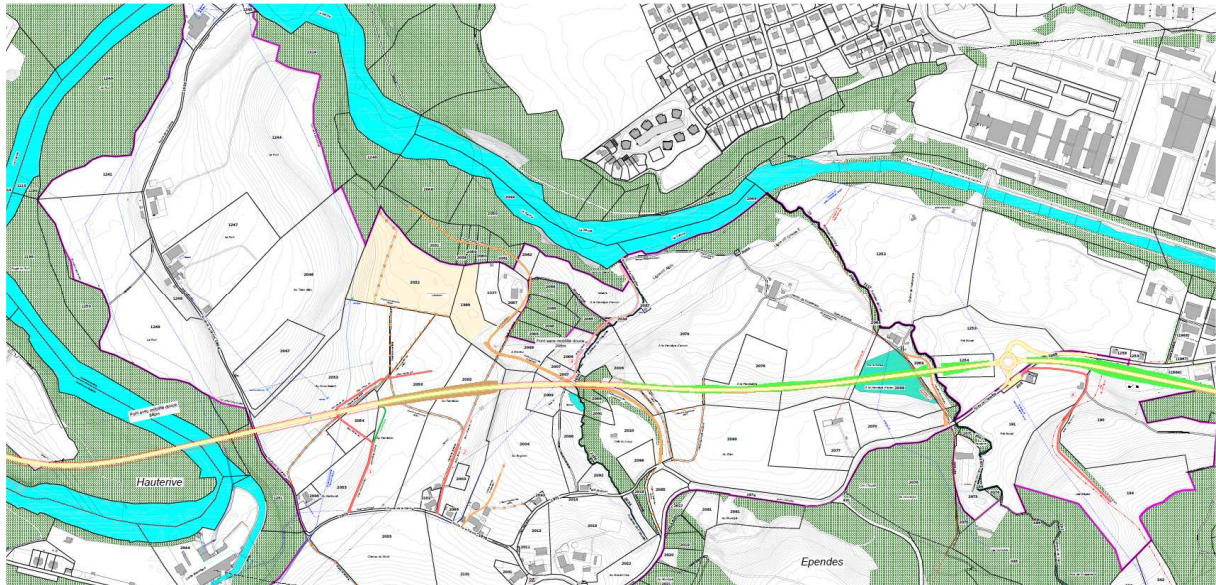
Extrait du plan de remaniement parcellaire [25]
